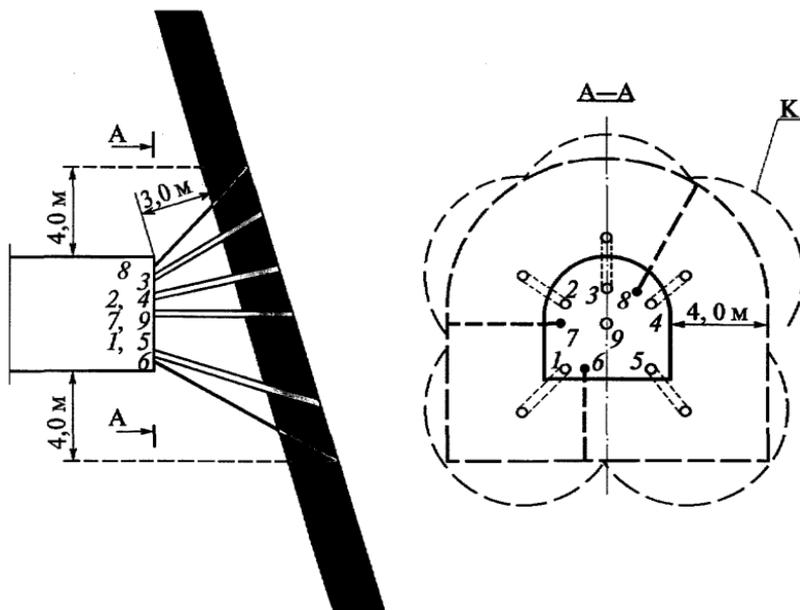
Схема расположения скважин для гидрорыхления угольного пласта при вскрытии угольного пласта крутого залегания:
